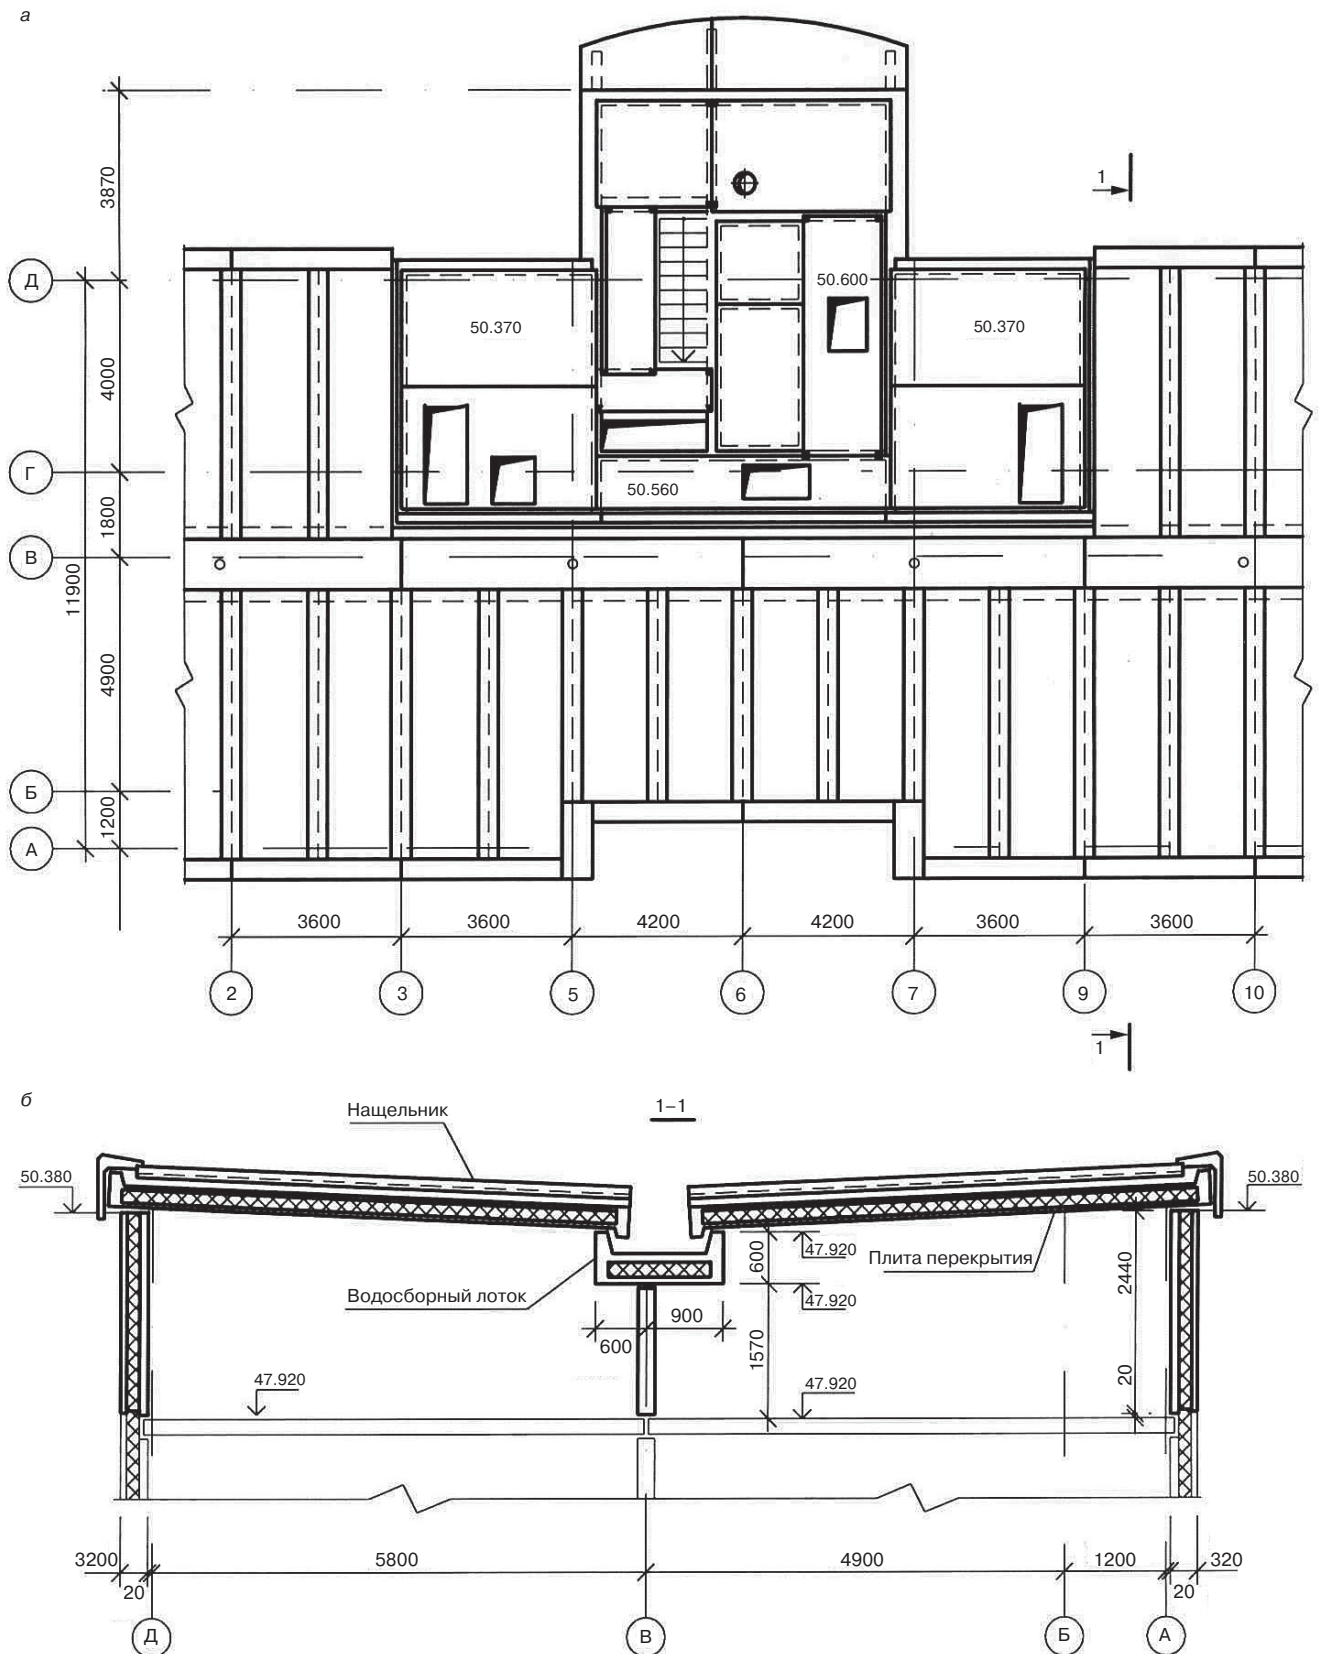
Конструктивное решение теплого чердака с безрулонной кровлей 16-этажной рядовой блок-секции дома серии И-155: а – план плит покрытия безрулонной кровли; б – разрез
